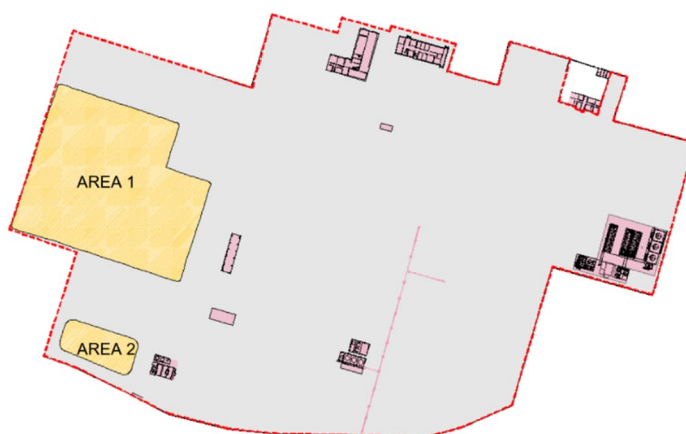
Pavimentazioni oggetto di demolizione, indicate in giallo
